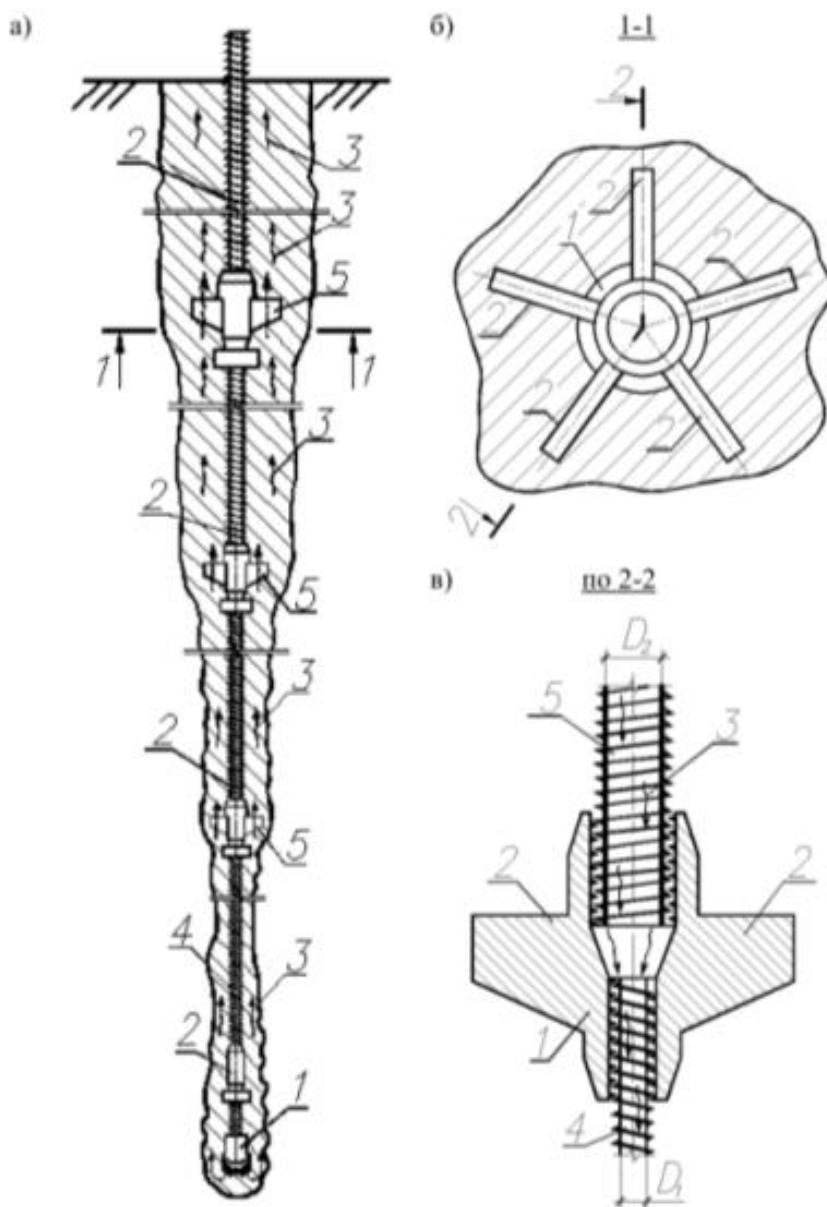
Конструкція буроін'єкційної конічної палі: а – повздовжній перетин буроін'єкційної конічної палі; б – поперечний перетин буроін'єкційної конічної палі; в – розріз 1-1; 1 – коронка (долото); 2 – з'єднувальна муфта; 3 – дрібнозернистий бетон; 4 – штанга; 5 – з'єднувальна муфта забезпечена буровим інструментом (муфта-коронка)
